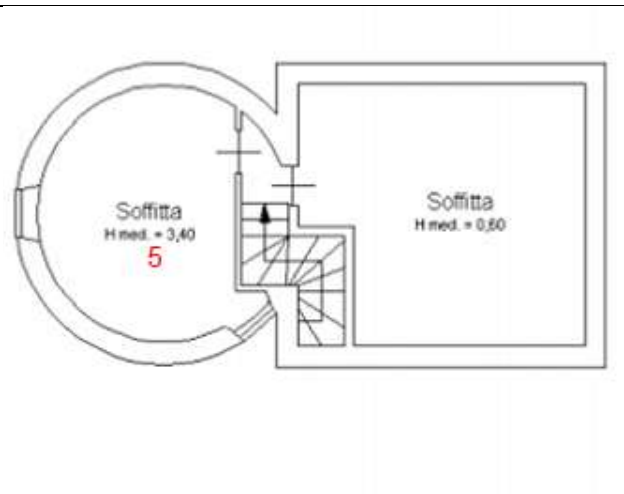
Planimetria Catastale Fg.7 Part.662 Sub.501 - P.2 con individuazione numerica delle difformità
